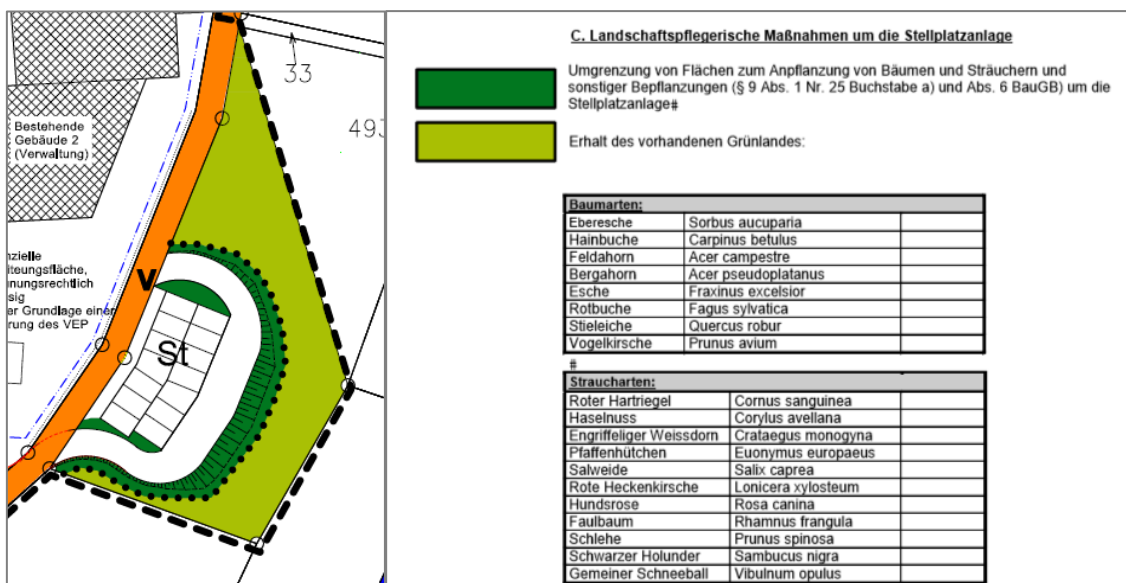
Auszug aus dem VEP 49 'Beuke' mit den Festsetzungen zu den landschaftspflegerischen Maßnahmen um die Stellplatzanlage (BÜRO BÖHMER & PLANUNGSBÜRO GROß 2020).
